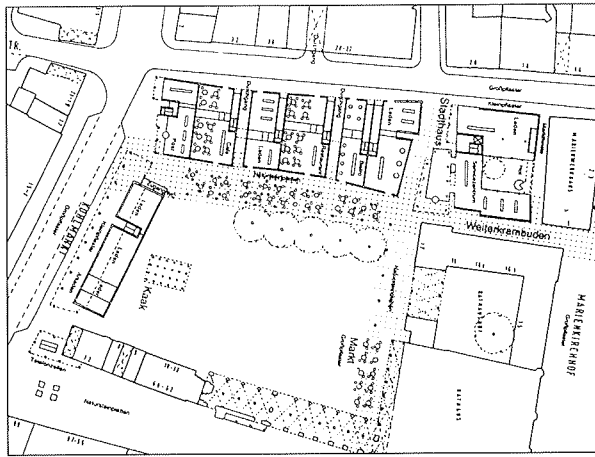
Lübeck. Markt, Neuüberbauung, Wettbewerbsprojekt 1. Preis, Grundriss Erdgeschoss. Böge und Lindner-Böge, Hamburg, 1996.
